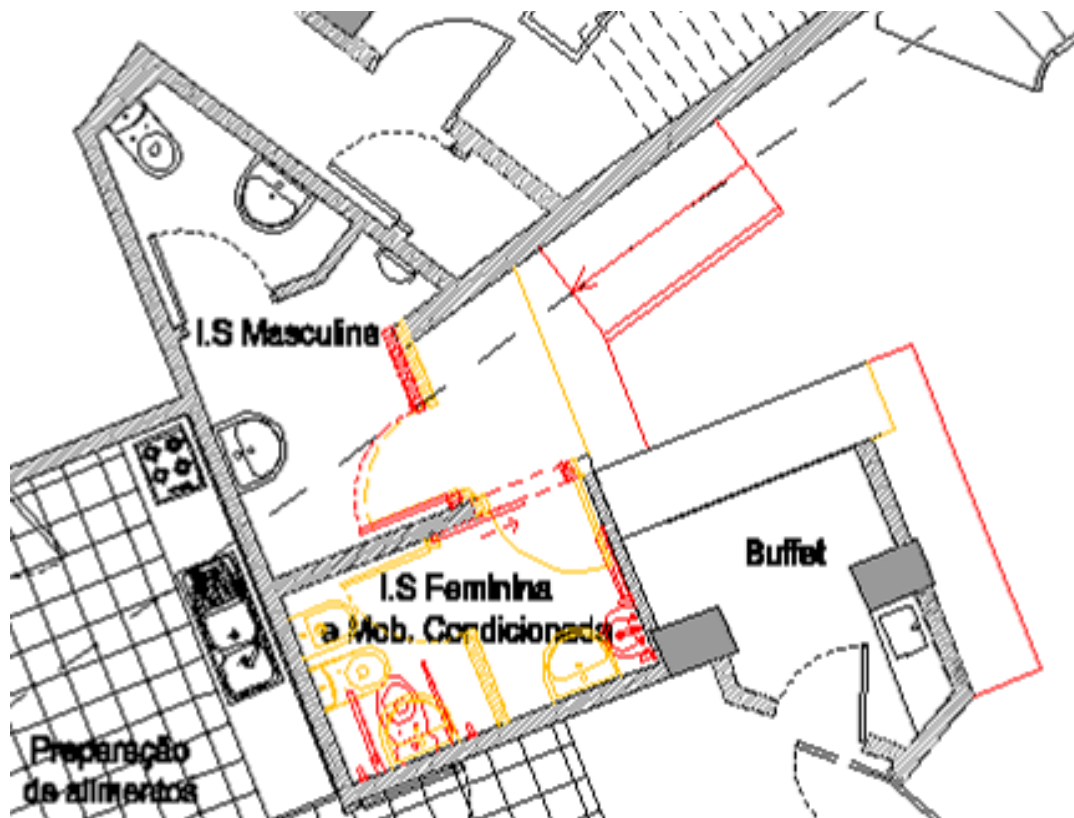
Planta do piso -1 na zona I.S. sociais da sala de refeições [Atelier B2, 2016]
